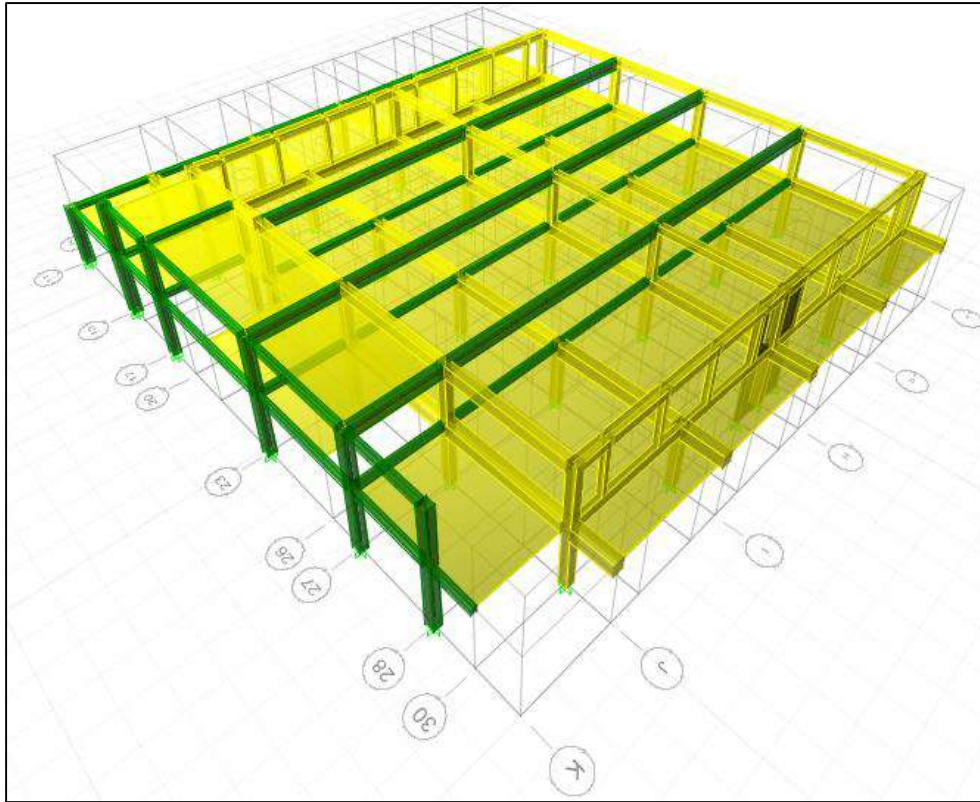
Elementos estructurales nuevos Estructura 5.32 Reforzamiento
